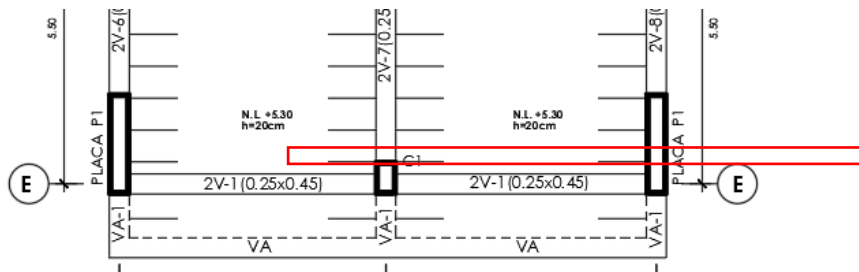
Concreto Armado, ubicación de vigueta a diseñar
